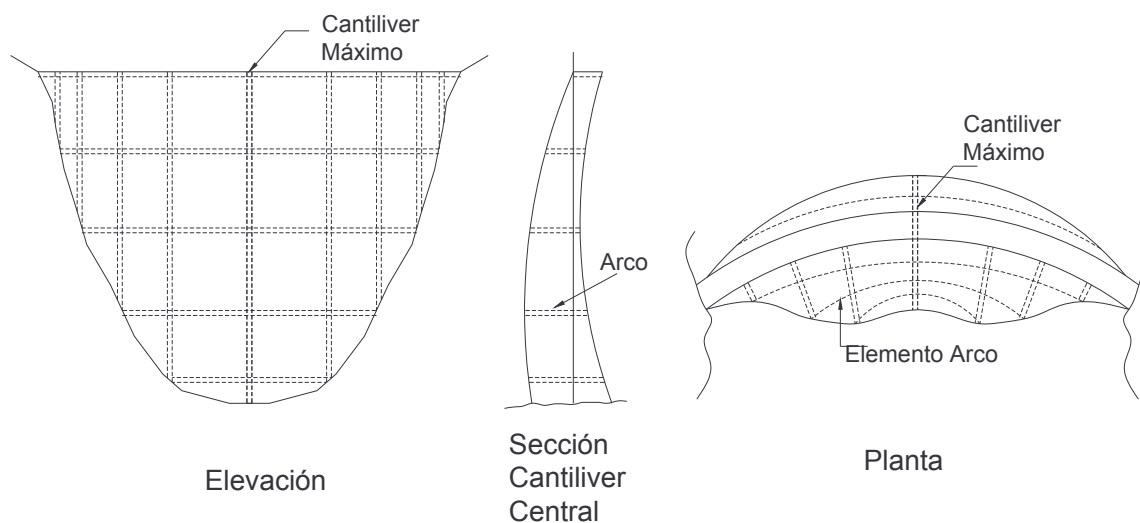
Planta, elevación y sección de una presa de arco.
